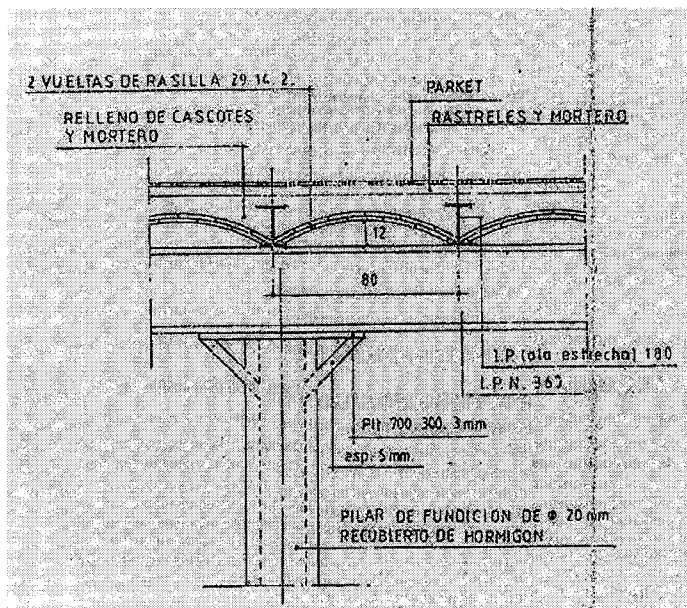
Detalle del forjado de vigueta metálica y bovedilla cerámica tomado de los planos arquitectónicos originales.
